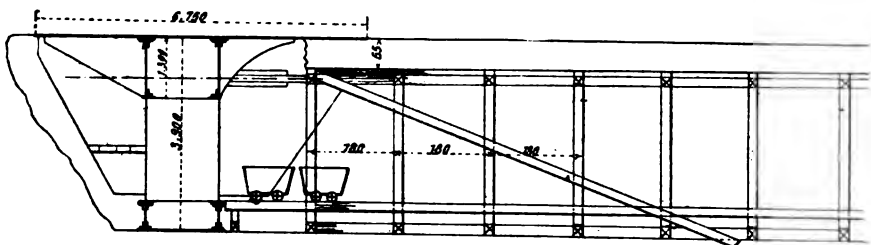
Coupe longitudinale du chantier montrant les étais.
